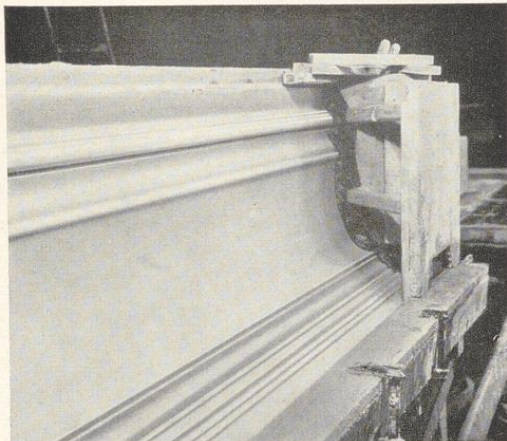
Hoher Tischzug mit gut verstreuter Mittelschablone
